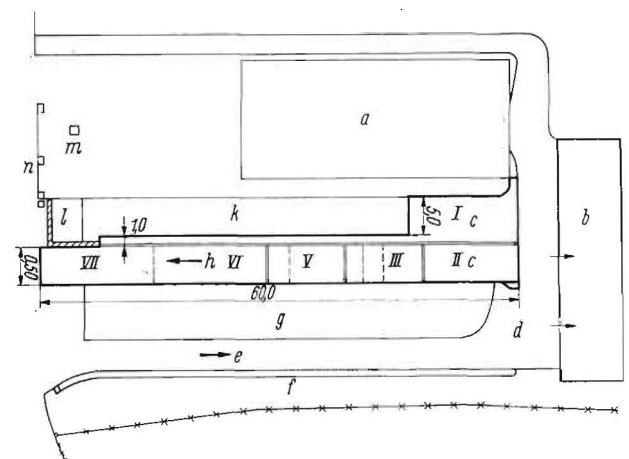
Lage der Versuchsstrecke „Zementschotter“ in Brünlos (Erzgeb.). a Werkstatt, b Maschinenhalle, c Zementschotterdecke, d sandgeschlämmte Schotterdecke, e Auffahrt (sandgeschl. Schotterdecke), f offener Graben, g Standfläche (Rasen), h Abfahrt, i Längsfuge, k Standfläche (sandgeschl. Schotterdecke), l Rampe (Rasen), m Tankstelle, n Poststraße (sandgeschl. Schotterdecke)
